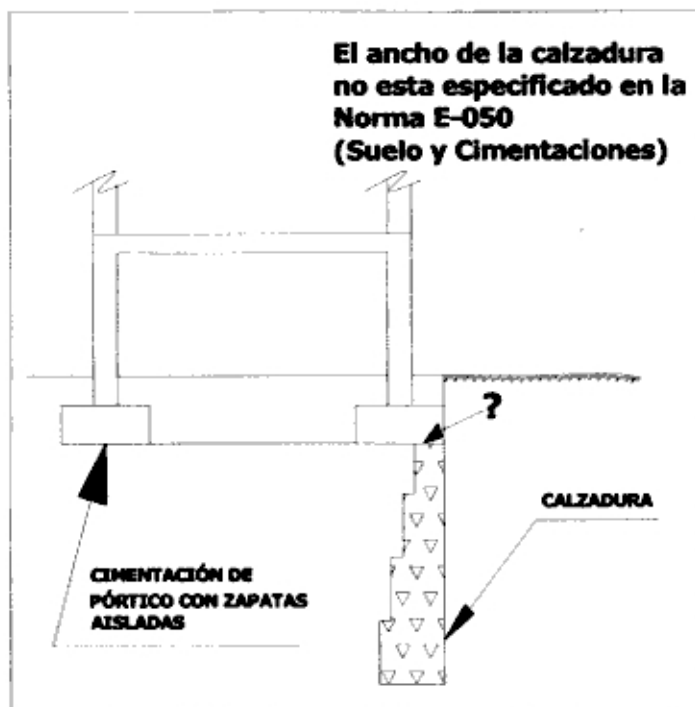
Calzada en un sistema de pórticos con zapatas aisladas
